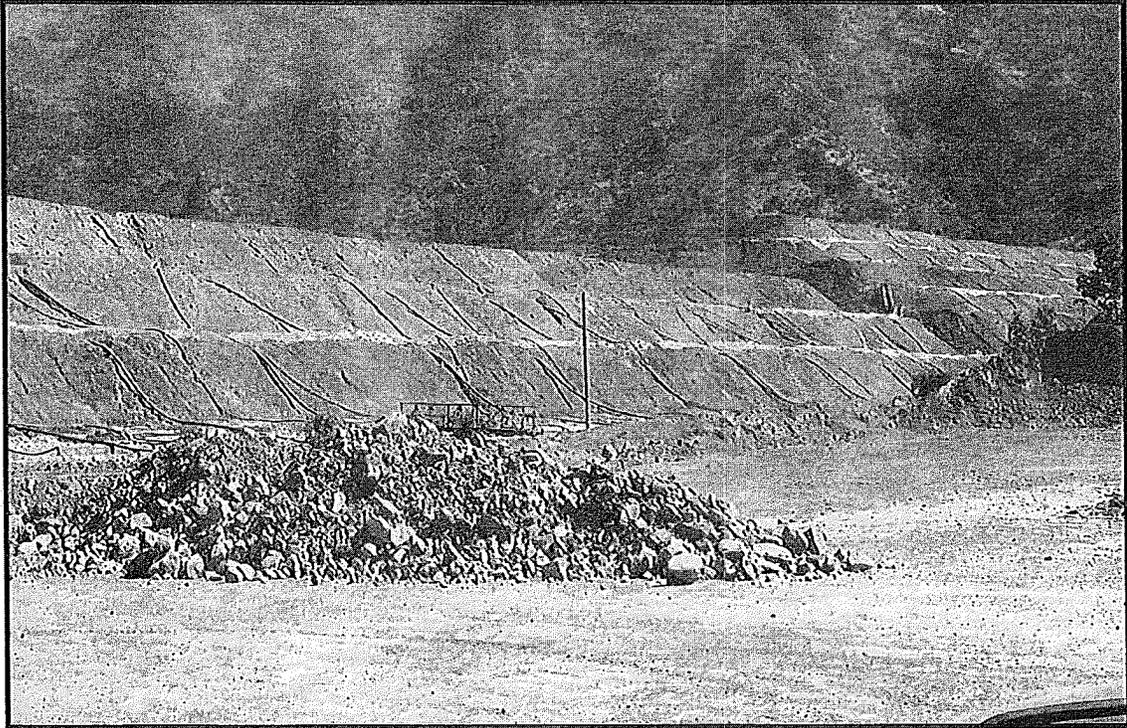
Sector 2 de pilas de lixiviación permanentes.
